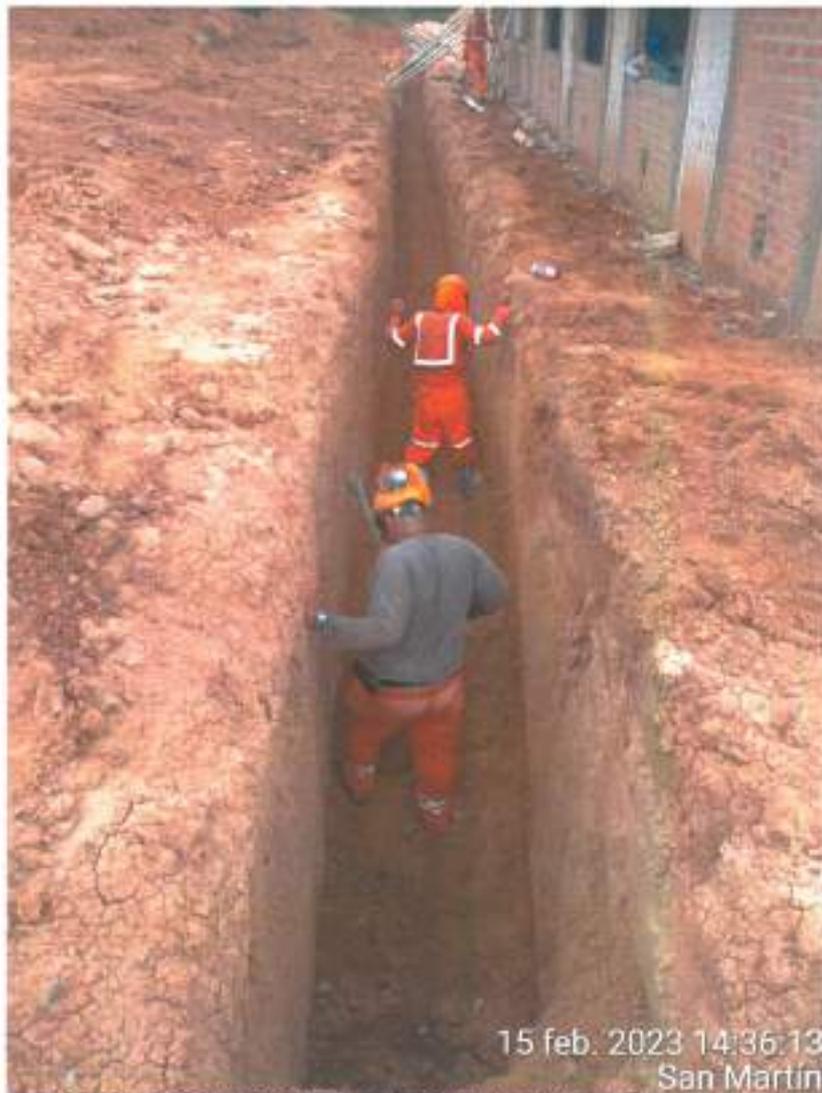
EXCAVACION PARA LA CIMENTACIÓN DEL TRAMO 5-1
